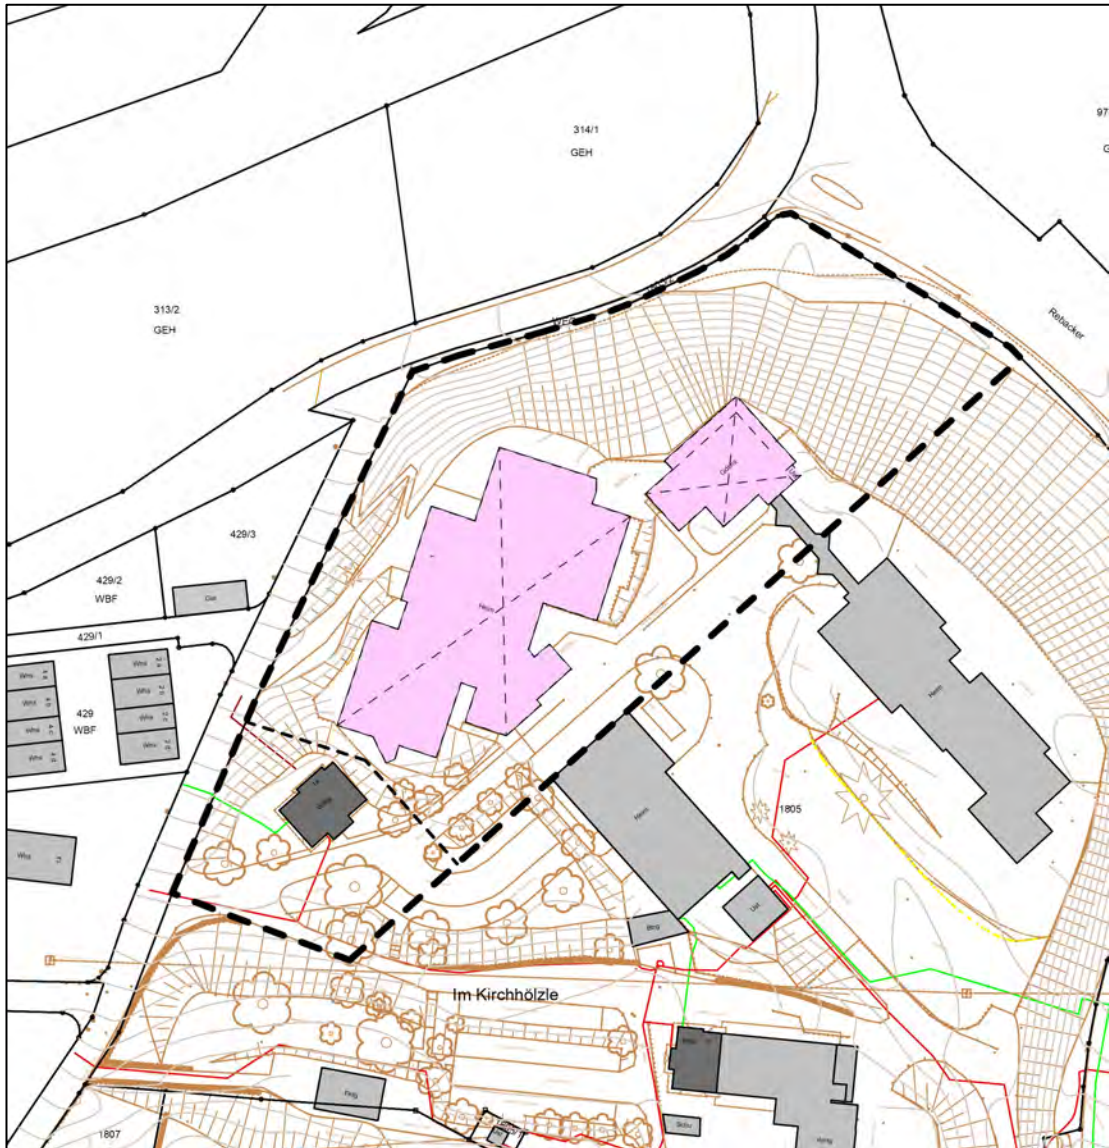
Darstellung des Wettbewerbsbereichs mit Abrissgebäuden, und Vermessung mit Höhenlinien mit Stützmauern. Quelle: Frey & Ganter. 2020.
